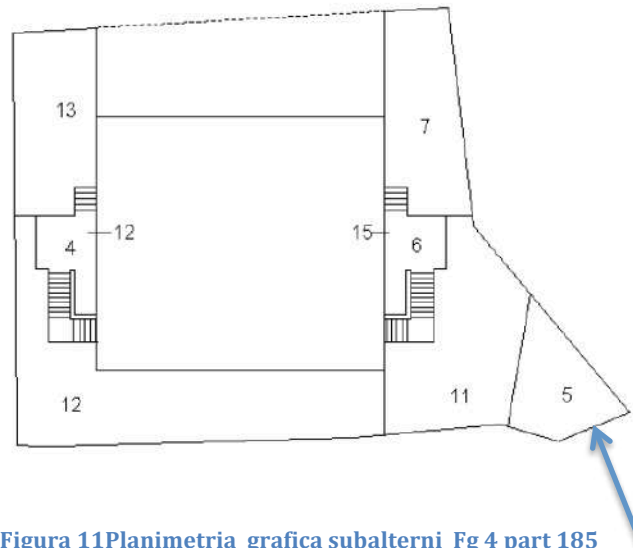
Planimetrica grafica subalterni Fg 4 part 185
